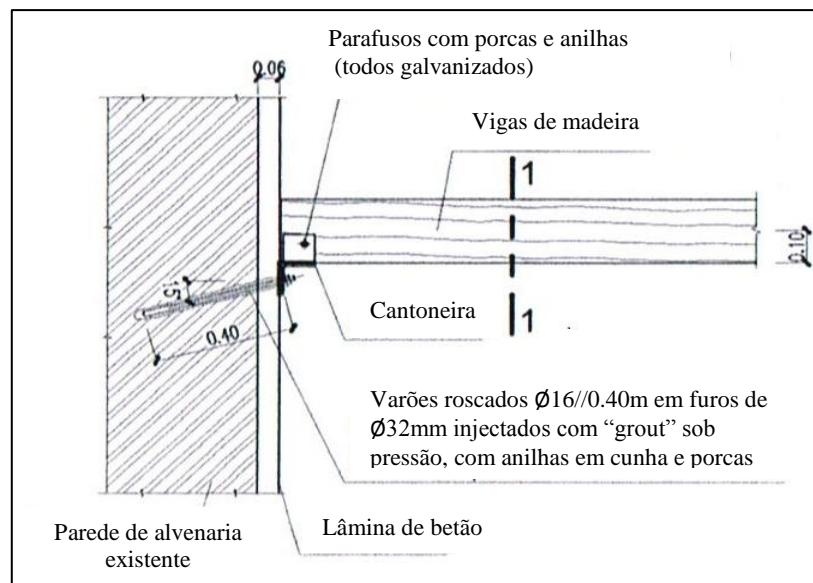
Ligação das vigas de madeira às paredes de alvenaria (Fonte: projecto do Edifício da Rua do Alecrim da empresa a2p)
